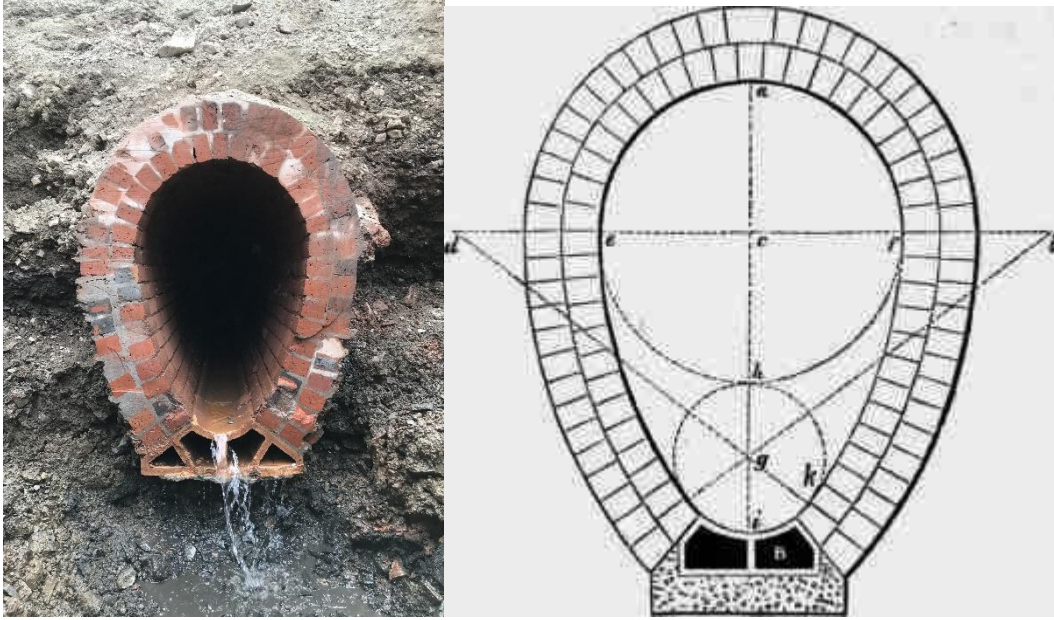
(स्रोत:<https://chestofbooks.com/architecture/Building-Construction-3-2/Brick-Drains-And-Sewers.html>)
